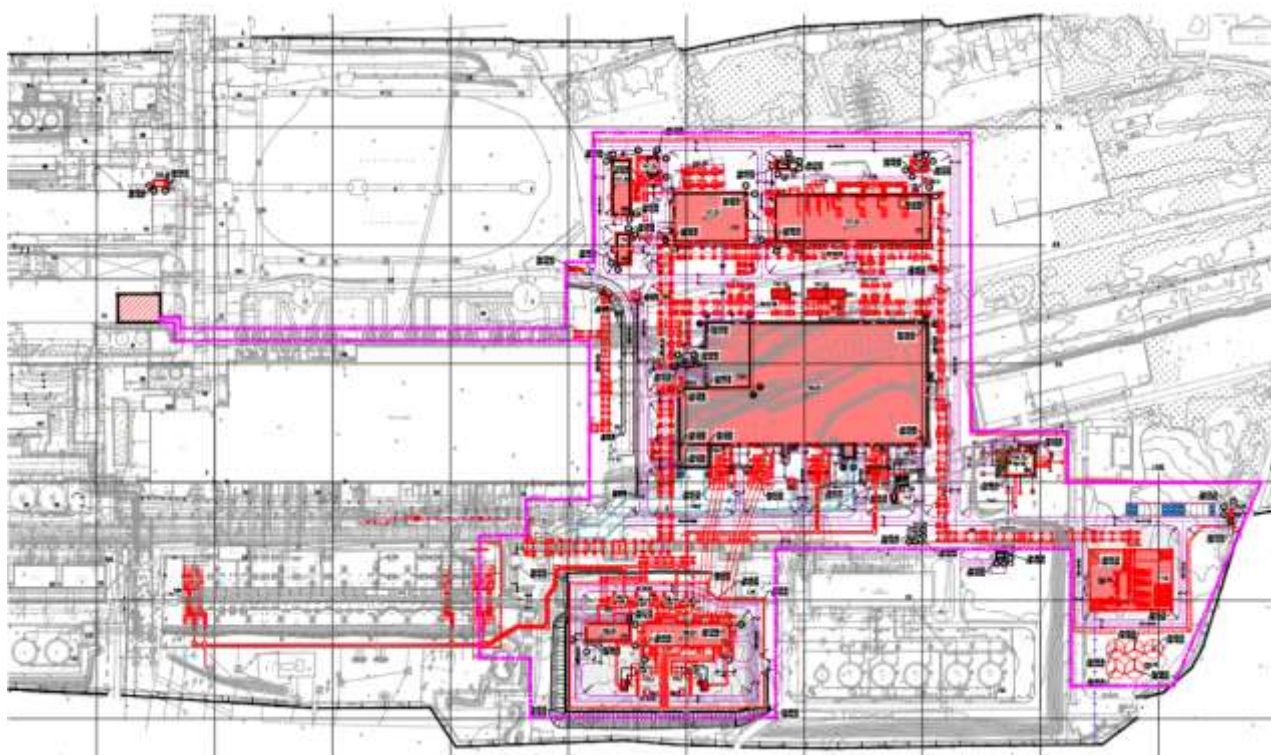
Схема генерального плана ГТ-ТЭЦ
